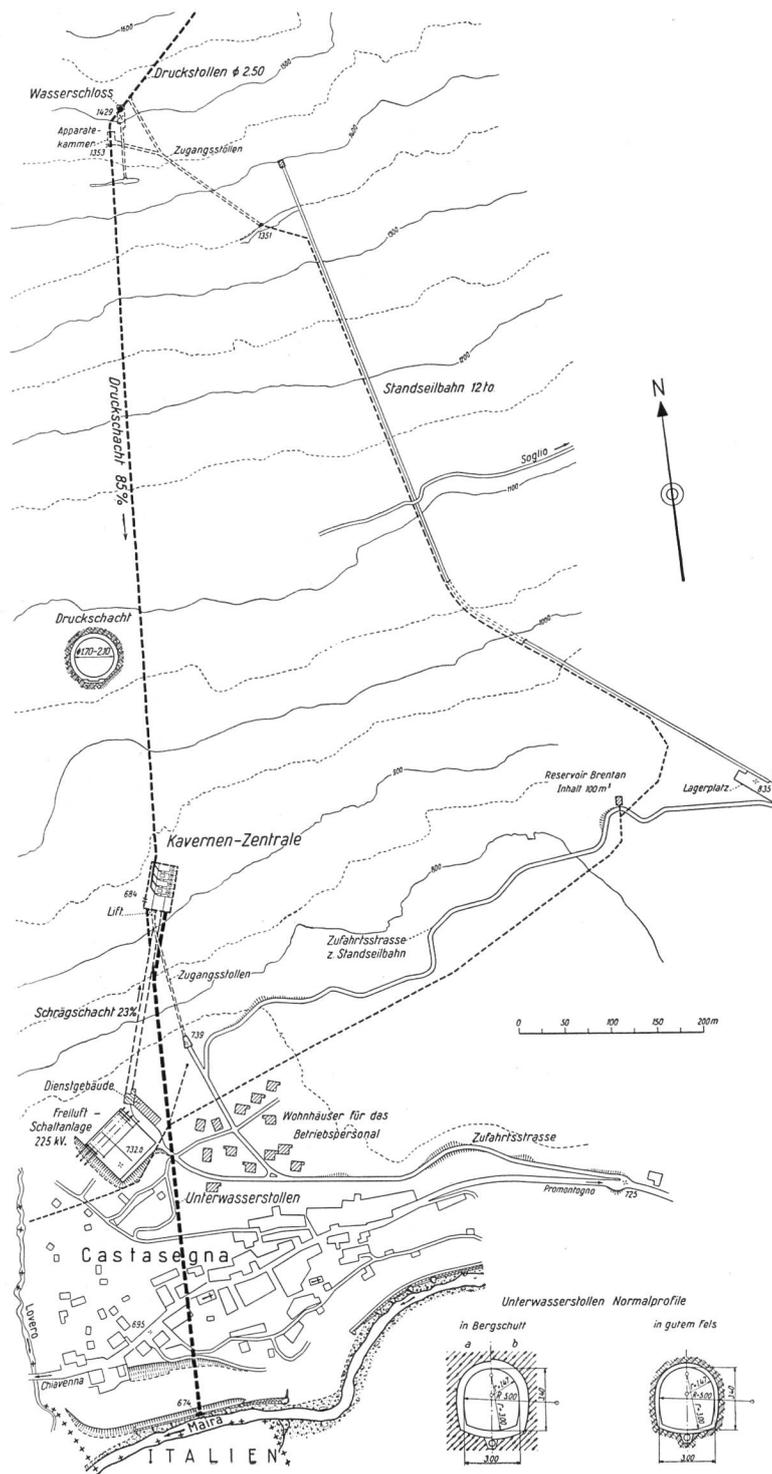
Lageplan von Wasserschloß, Druckschacht und Zentrale Castasegna.
